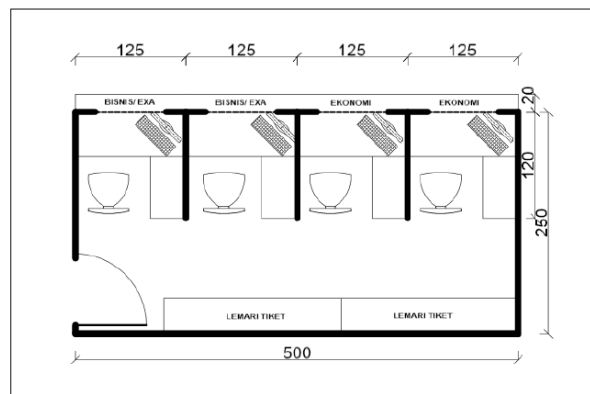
22 Tipikal Denah Ruang Peralatan
